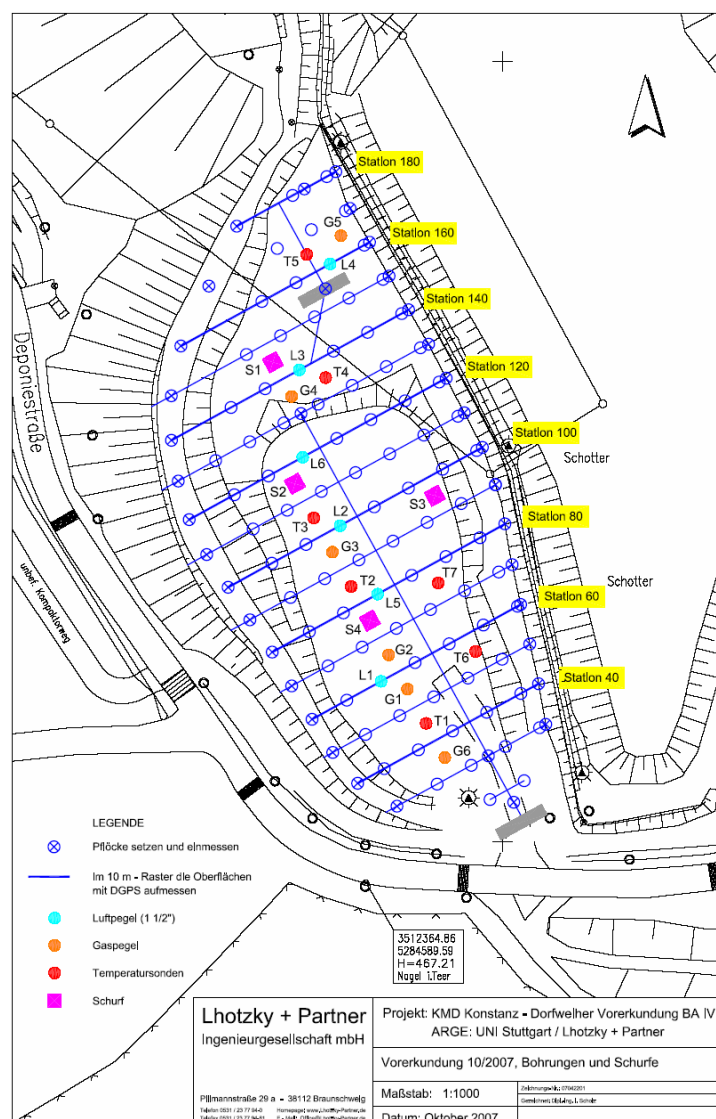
Lageplan vom Deponiebereich BA IV mit den Erkundungsbohrungen und Baggerschurfen.
